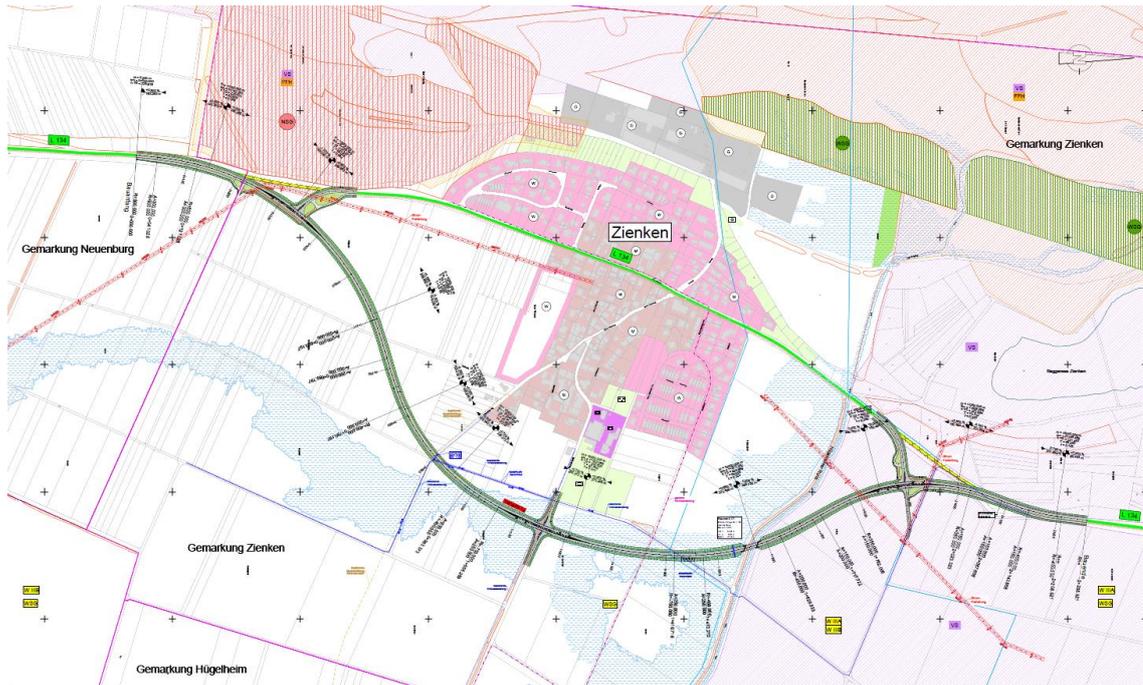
Lageplan Variante 1a (vgl. Unterlage Nr. U 5_1)
